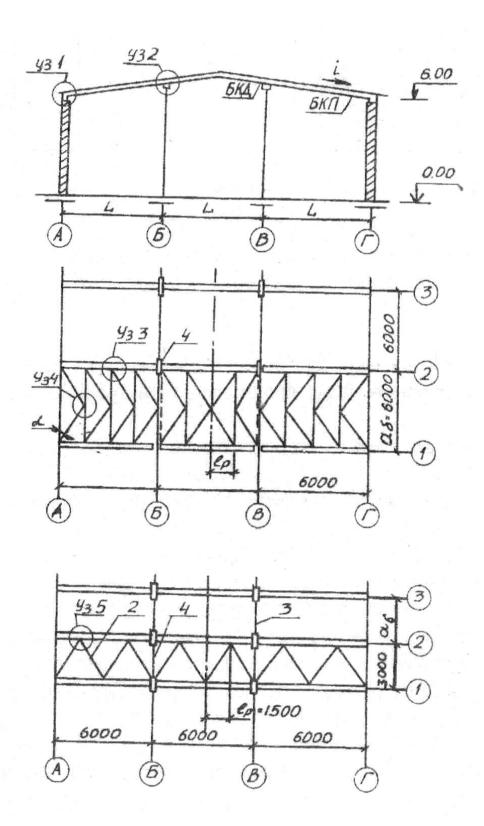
Общий вид и поперечный разрез деревянной балки покрытия
